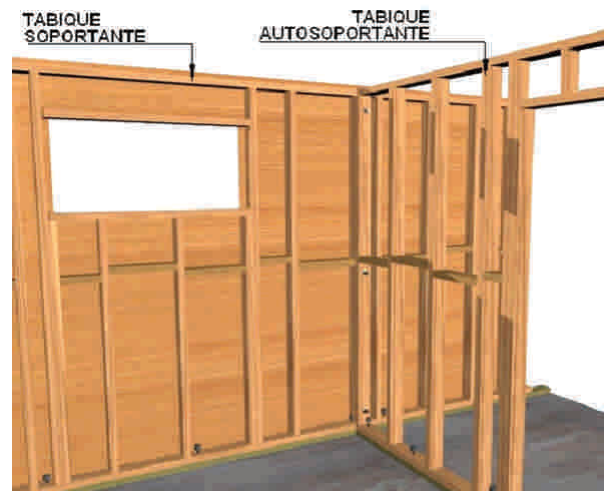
2b: Elevación exterior de un tabique soportante estructural prefabricado montado sobre su plataforma base.
